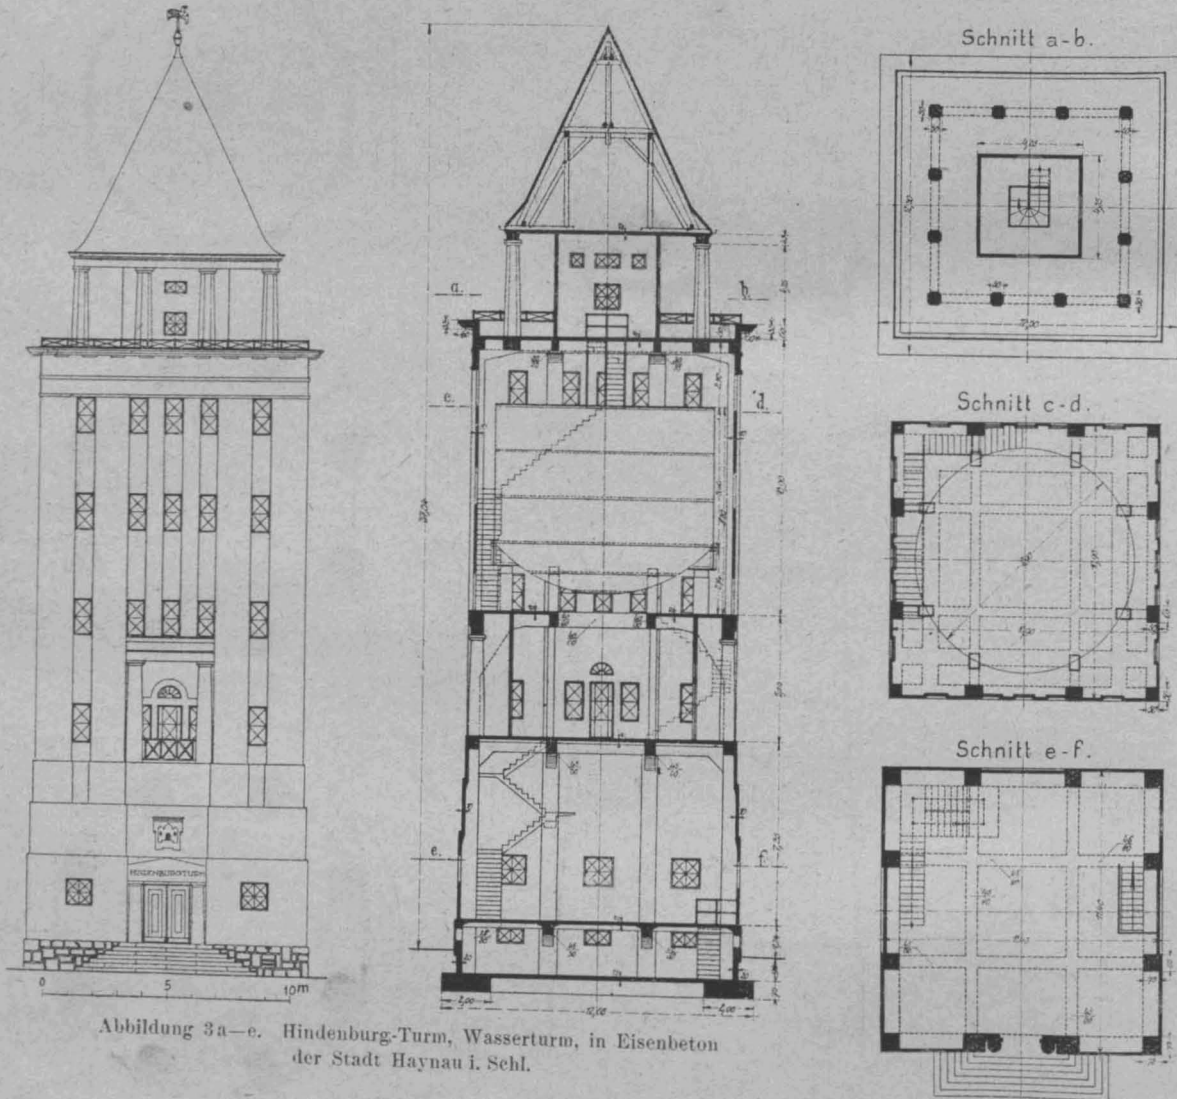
e. Hindenburg-Turm, Wasserturm, in Eisenbeton der Stadt Haynau i. Schl.
